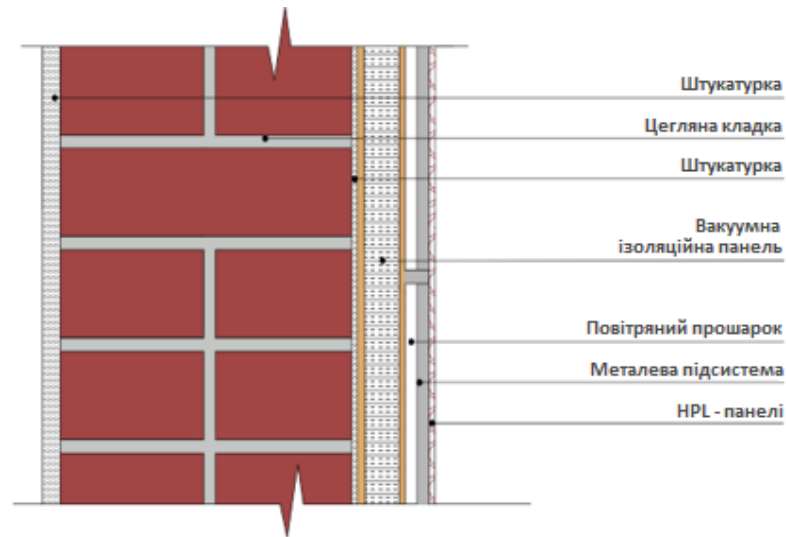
Конструкція зовнішньої стіни системи вентиляльованого фасаду
